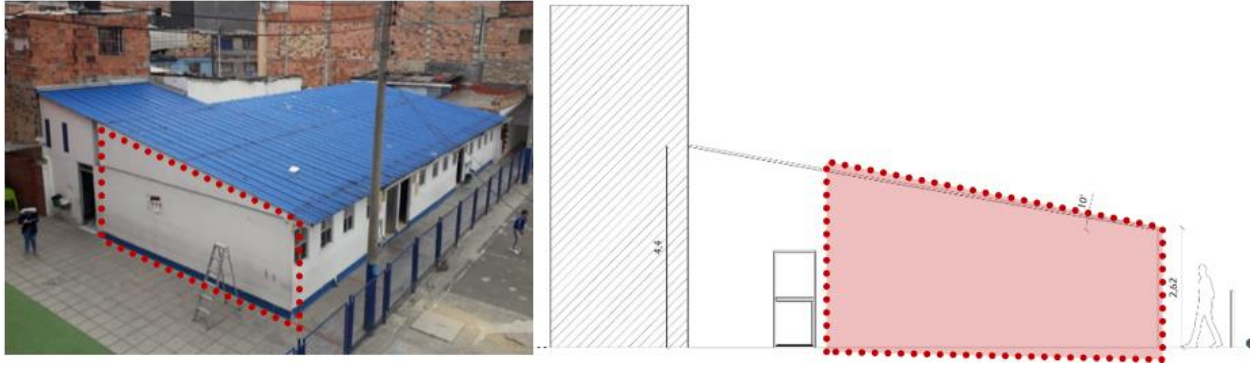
Sede preescolar Fachada sur / Muro de aplicación.
